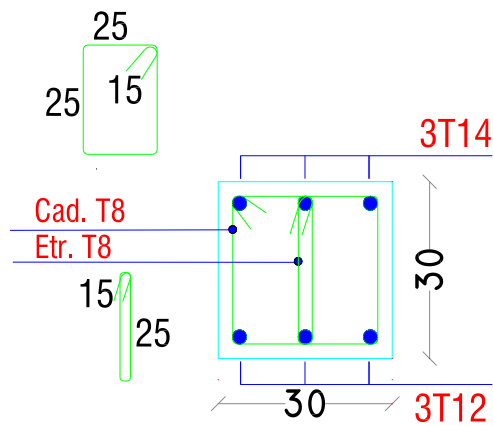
Ferrailage des poutres secondaire pour Etage 2,3,4,5,6,7 et 8.
